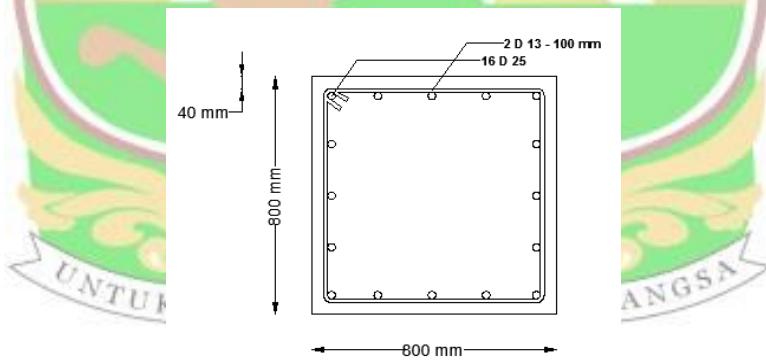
Detail Penulangan Balok Bangunan 1
